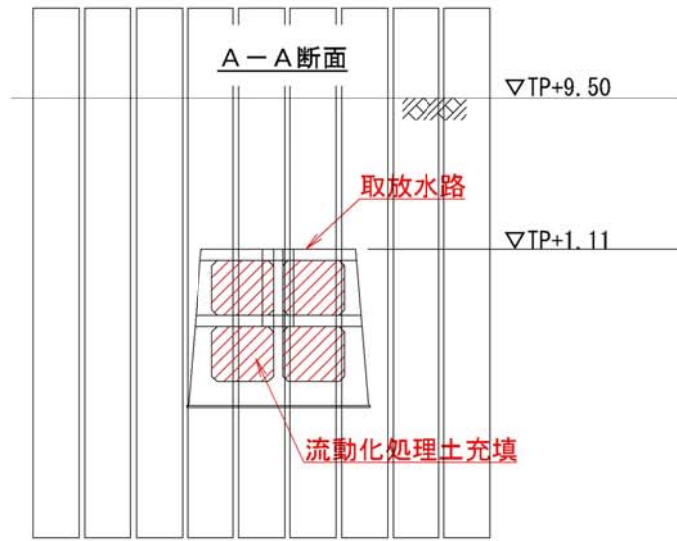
取放水路埋戻し位置断面図 (A-A断面)
